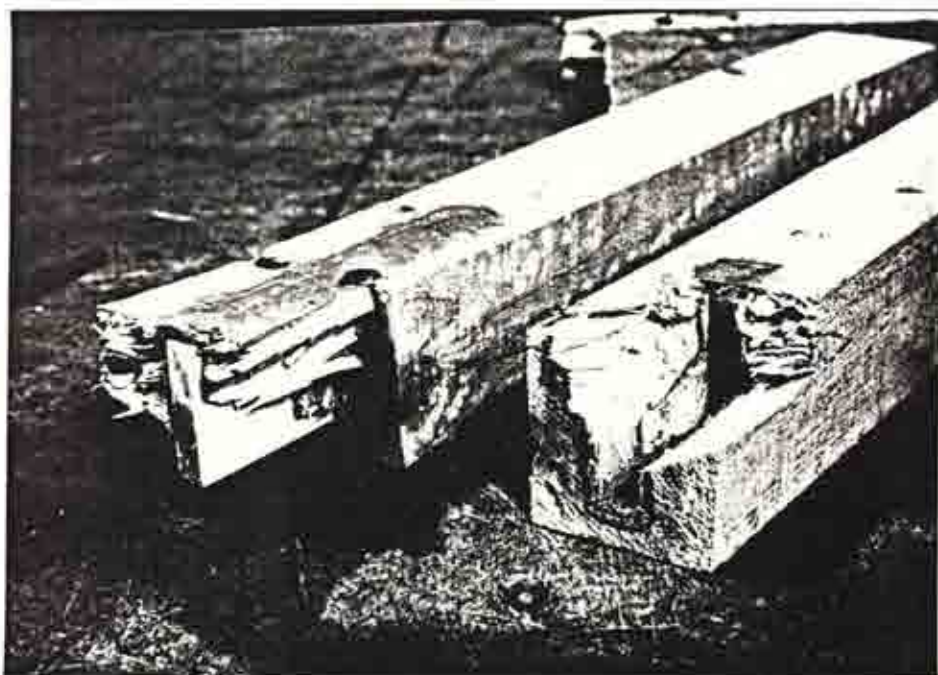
Detalle de la rotura del anclaje de una placa interna. Fallo por cortante de la madera. Se observa como la parte inferior de la placa no arranca madera y en cambio presenta fallo en la propia fibra en planos paralelos al de la placa.
